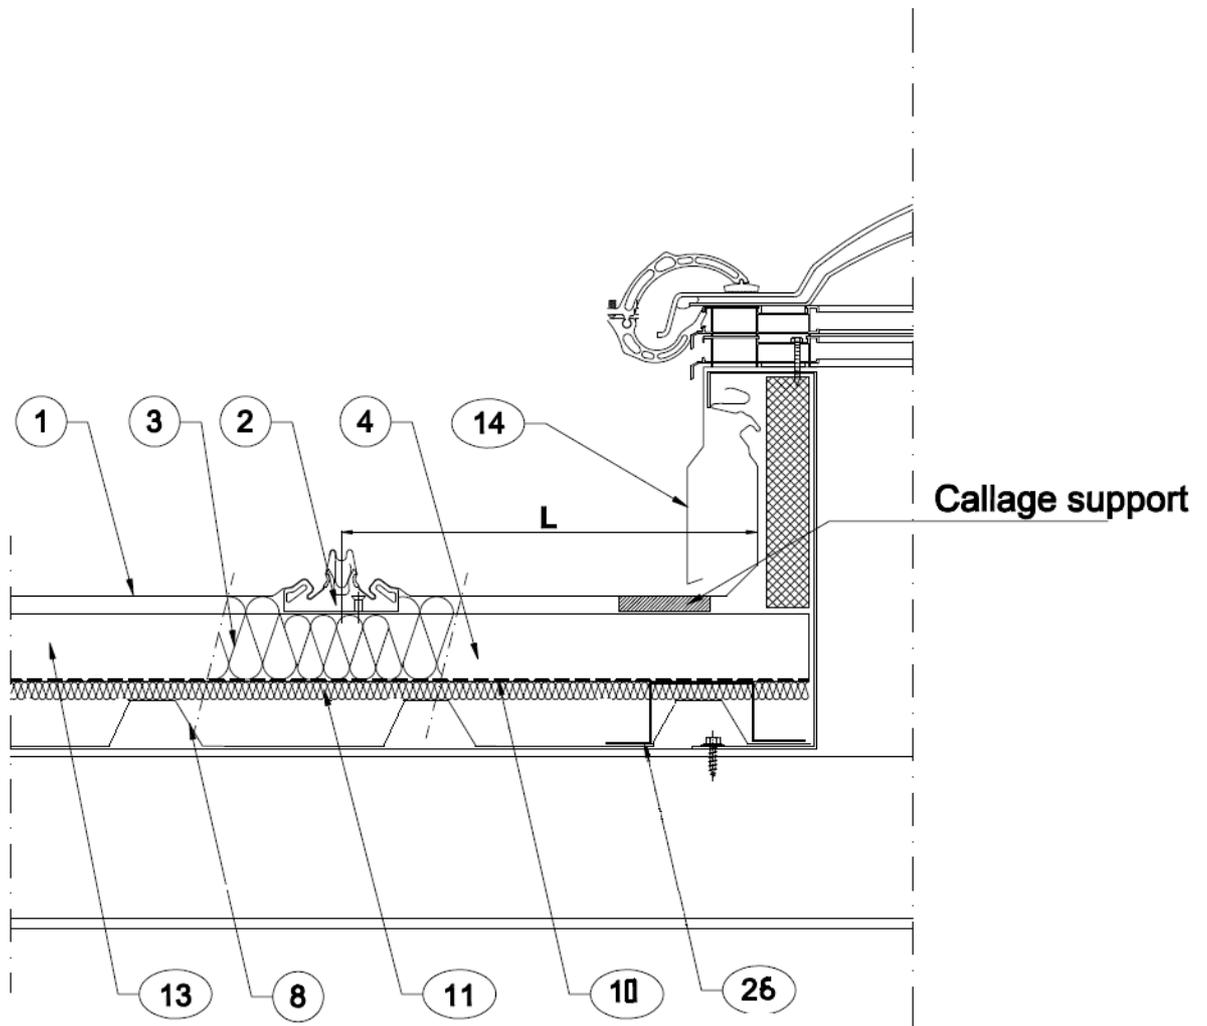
Détail sortie toiture - Lanterneau filant jusqu'au faitage
